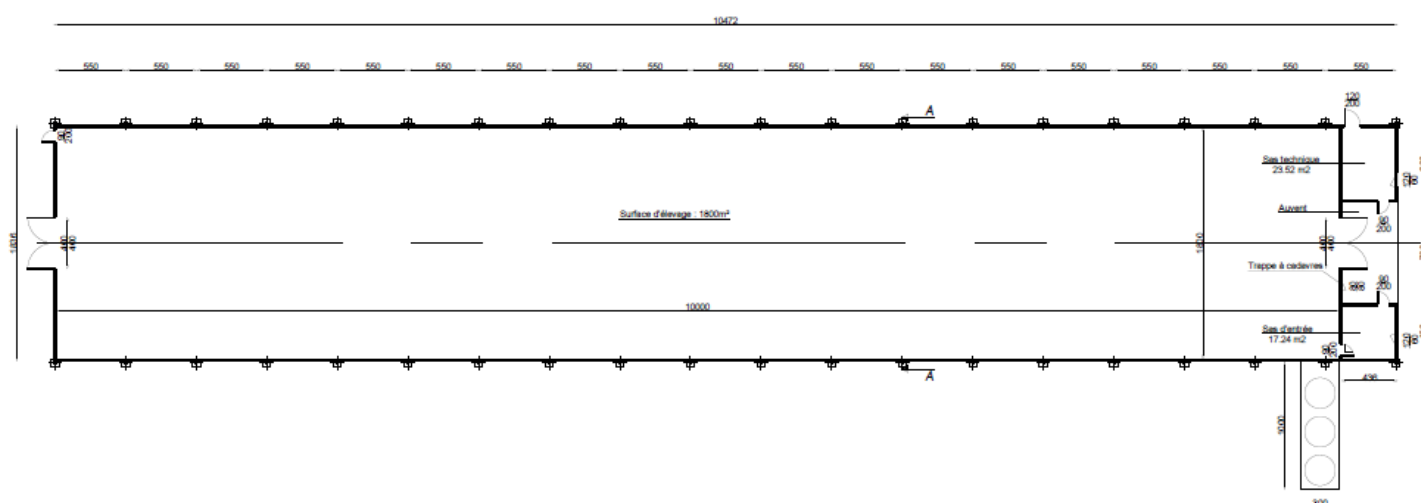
Plan du nouveau bâtiment volailles (extrait du permis de construire)
